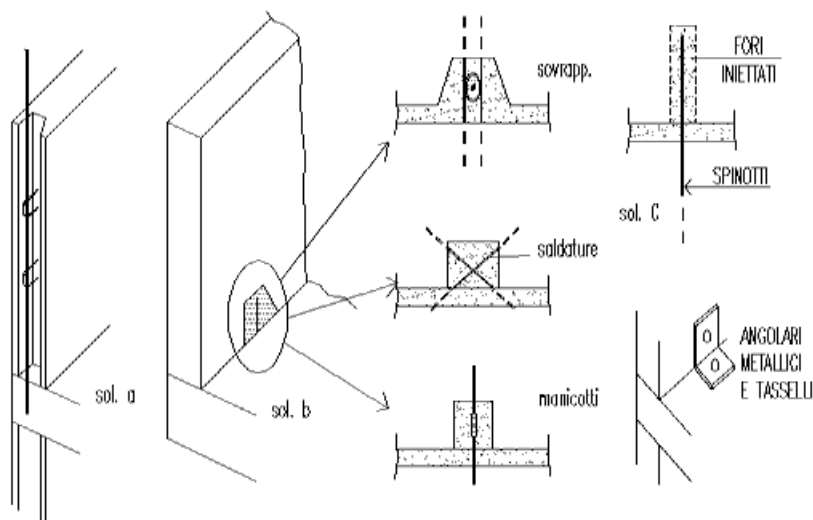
Armature tipiche di collegamento della base dei pannelli ai giunti orizzontali.
